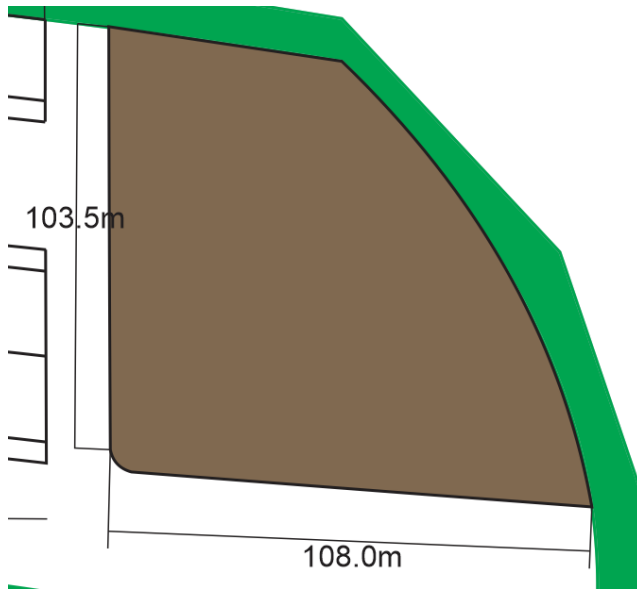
Imagen retomada del plano 12 “zonificación interna” resaltando la zona de la planta de tratamiento con cotas generales
